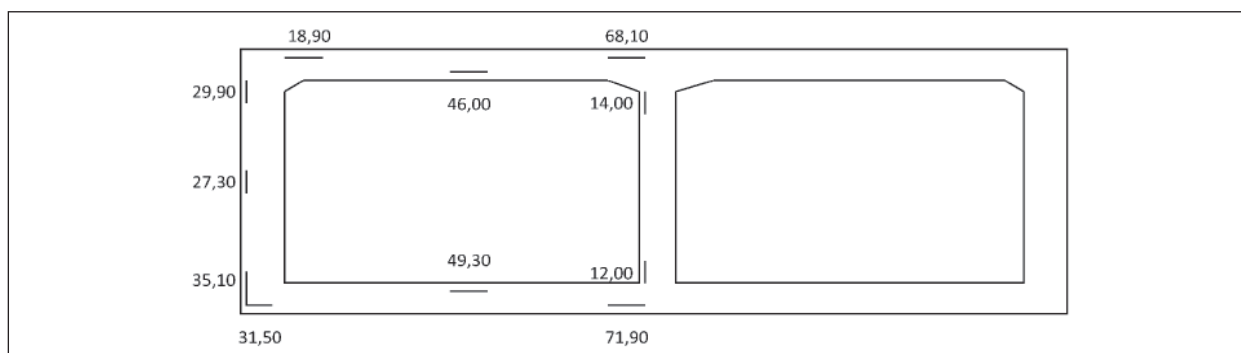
Tunnelquerschnitt RQ 26t mit maßgebender Bewehrung
